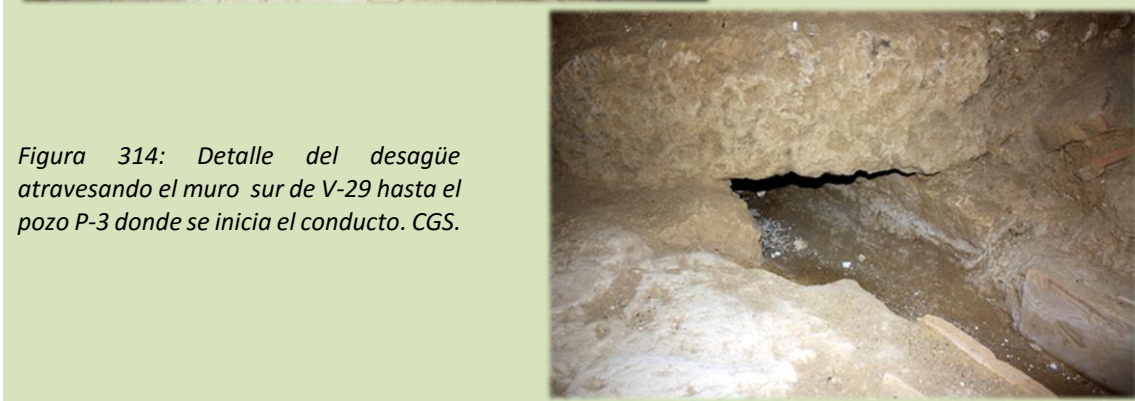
Detalle del desagüe atravesando el muro sur de V-29 hasta el pozo P-3 donde se inicia el conducto. CGS.
